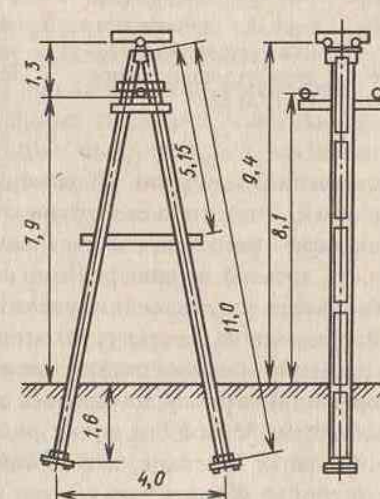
Железобетонная анкерная одноцепная опора ВЛ 10 кВ
